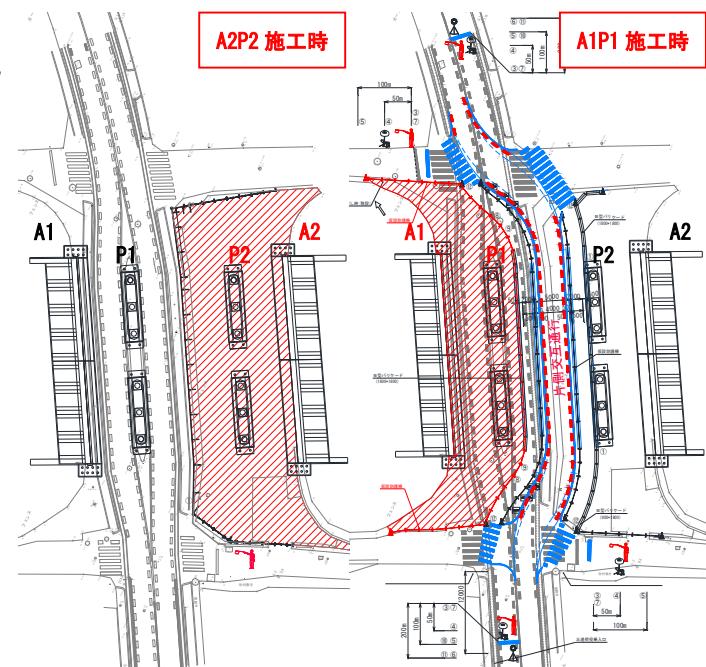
市道平面図(切回し前) 図-6 市道平面図(切回し後)
